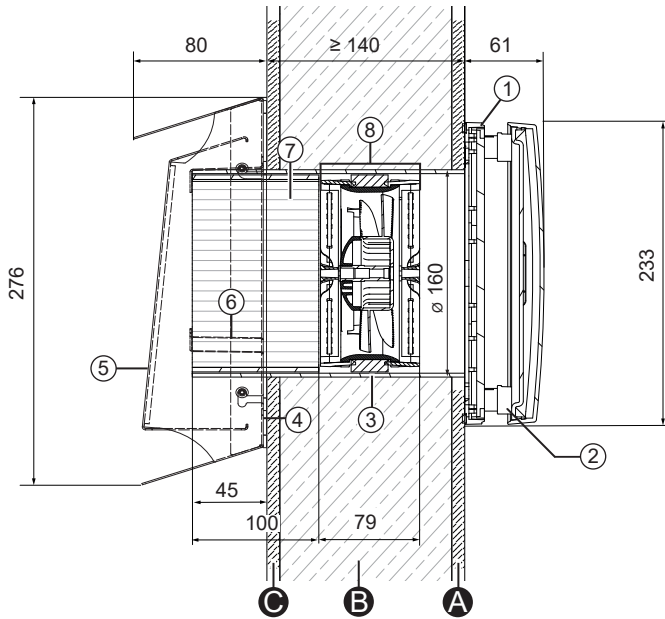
Schnittzeichnung Lüftungsgerät iv-Compact mit Wetterschutzhaube Compact
